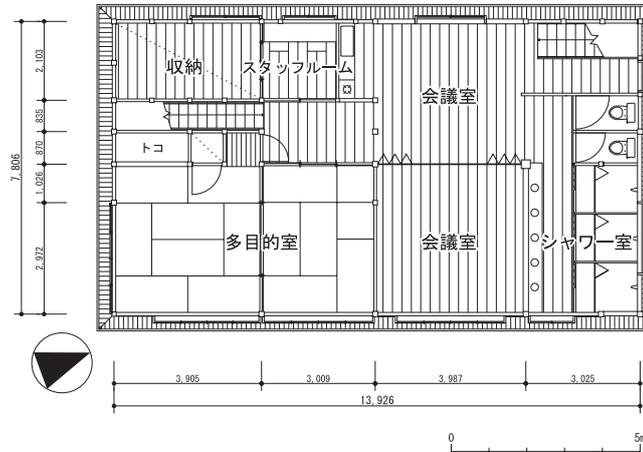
復原的改修案 2階平面図 S = 1 : 200 (設計：小林)
